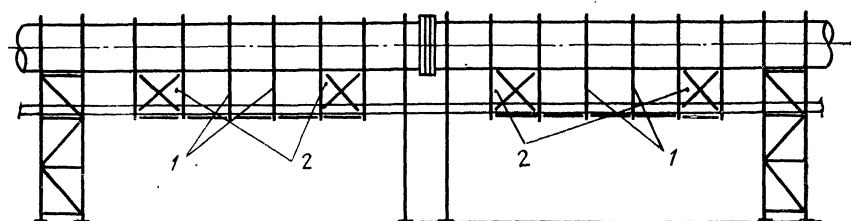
Пример связевой системы для подвески трубопроводов:
